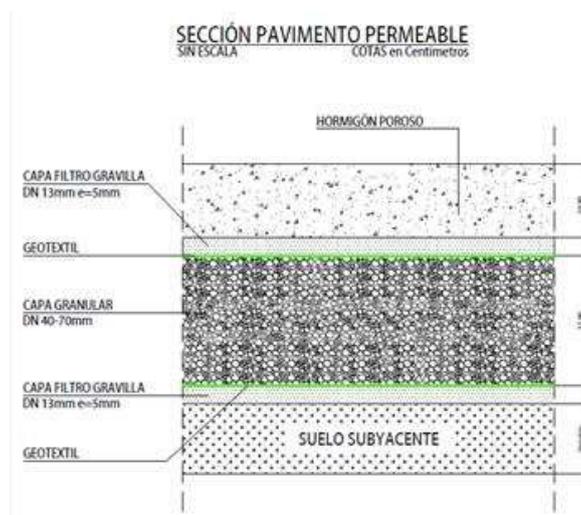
Sección del pavimento tipo SUDS bajo el carril bici
